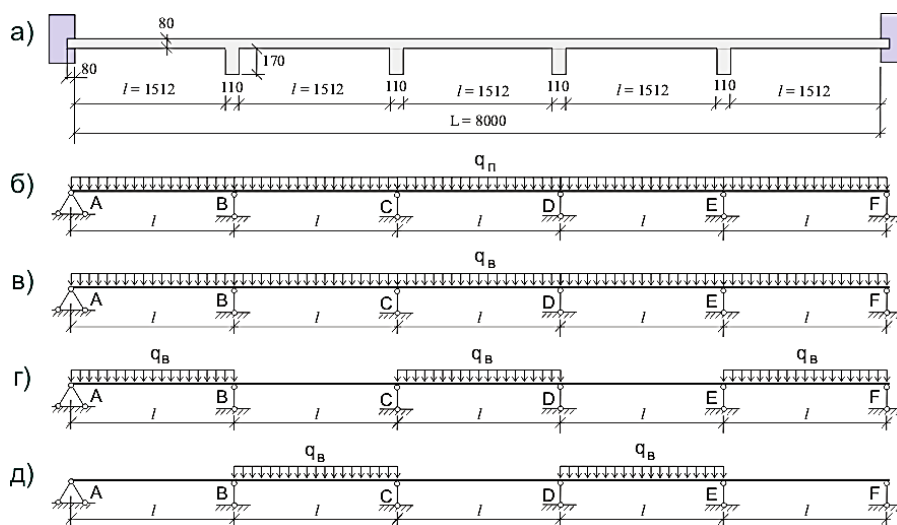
Расчетная схема для монолитного перекрытия по балкам
